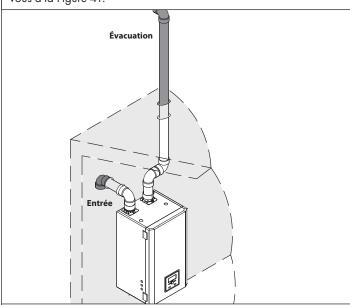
Ventilation non équilibrée - Évacuation de toit et entrée latérale
